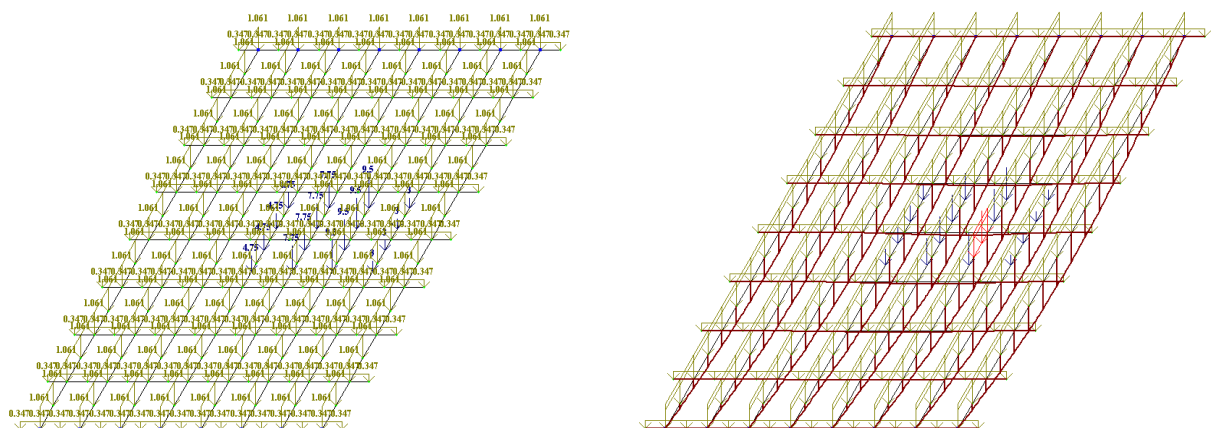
Розрахункова схема прогонової будівлі з прольотом 20,0 м (навантаження НК-100) та епюри моментів
